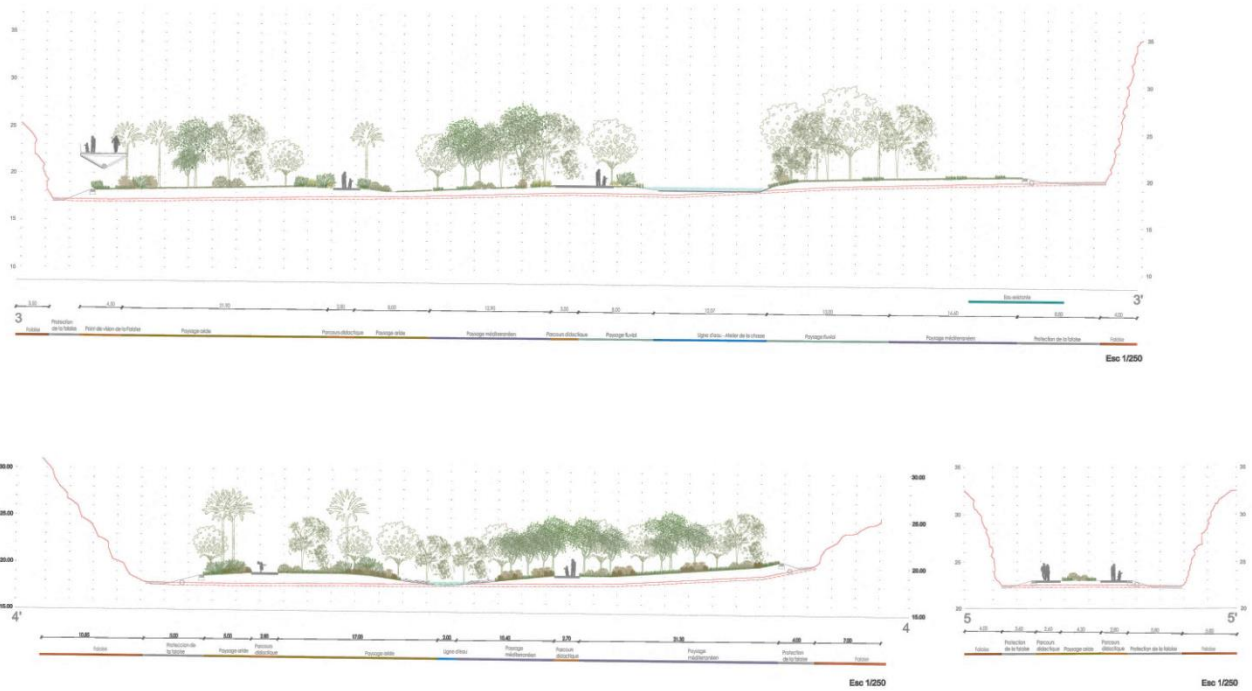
Cortes de Aterro e Escavação 3, 4 e 5.
